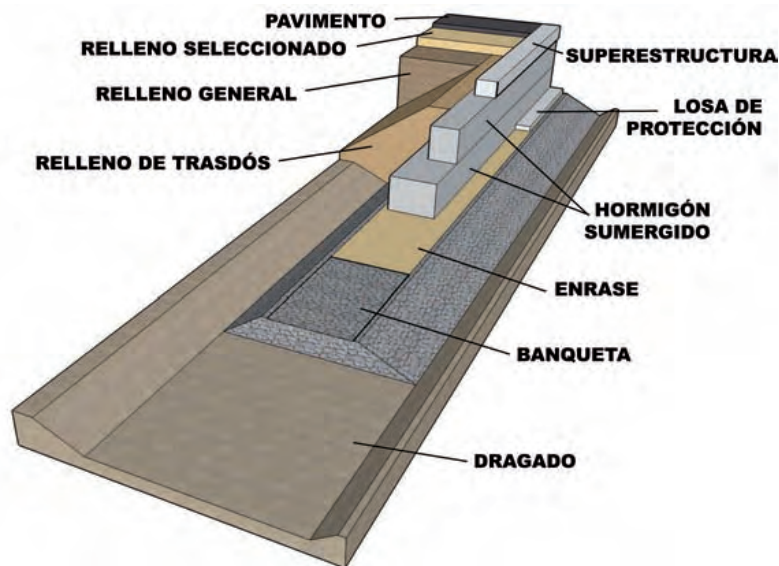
a B Secuencia constructiva muelle de hormigón sumergido
